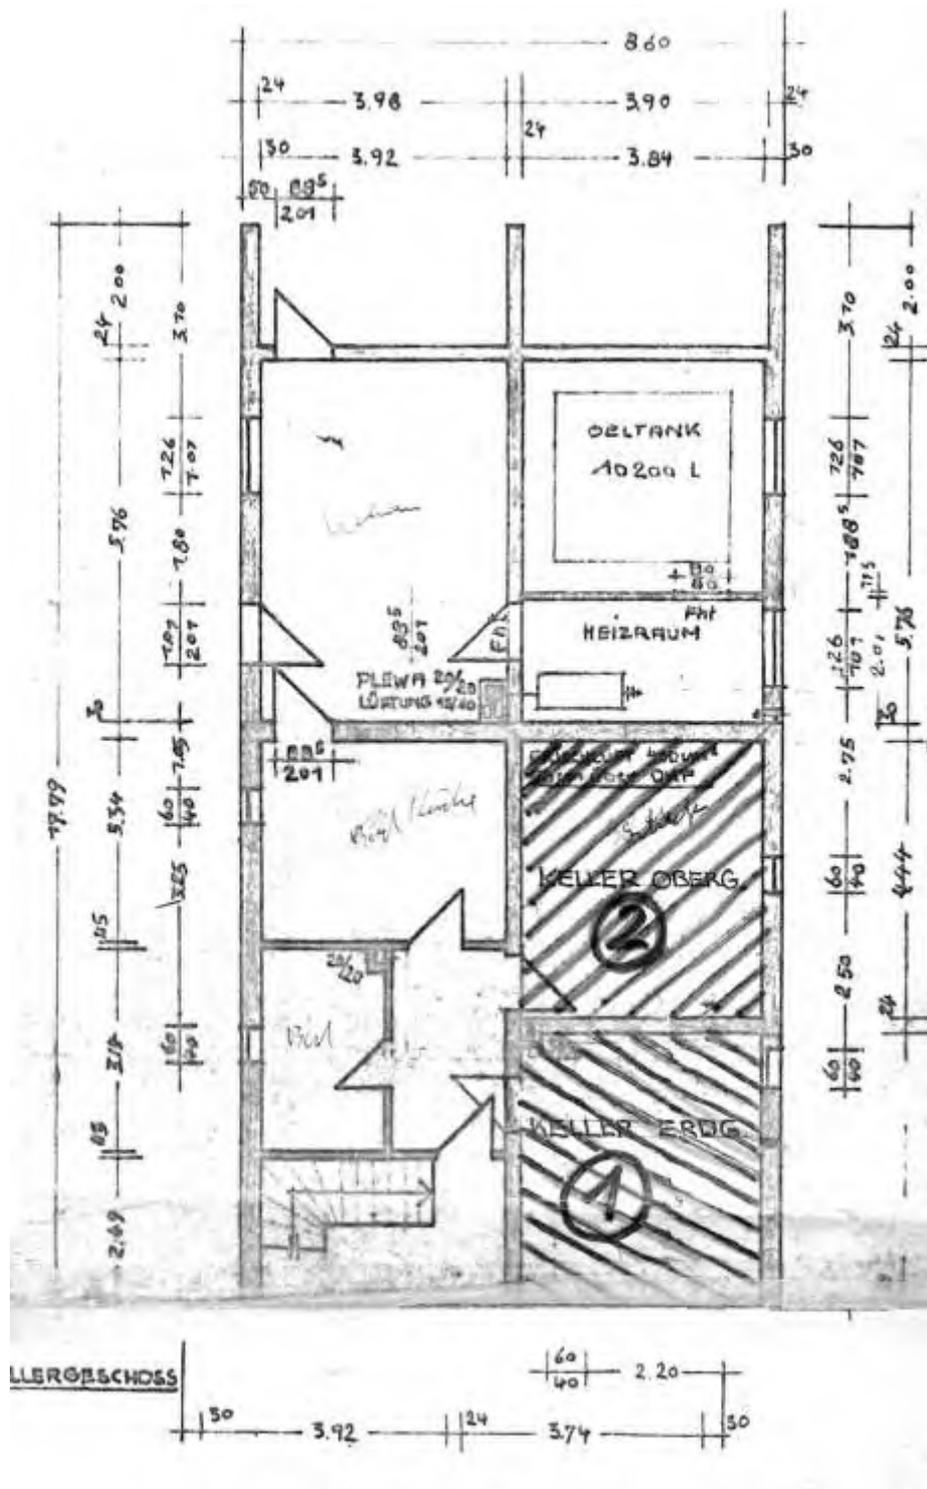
Grundriss Kellergeschoss (Nr.1 = Bewertungsgegenstand)
